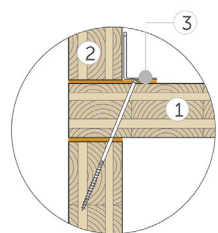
Detalle de la colocación de aislamiento acústico en estructura de CLT.
